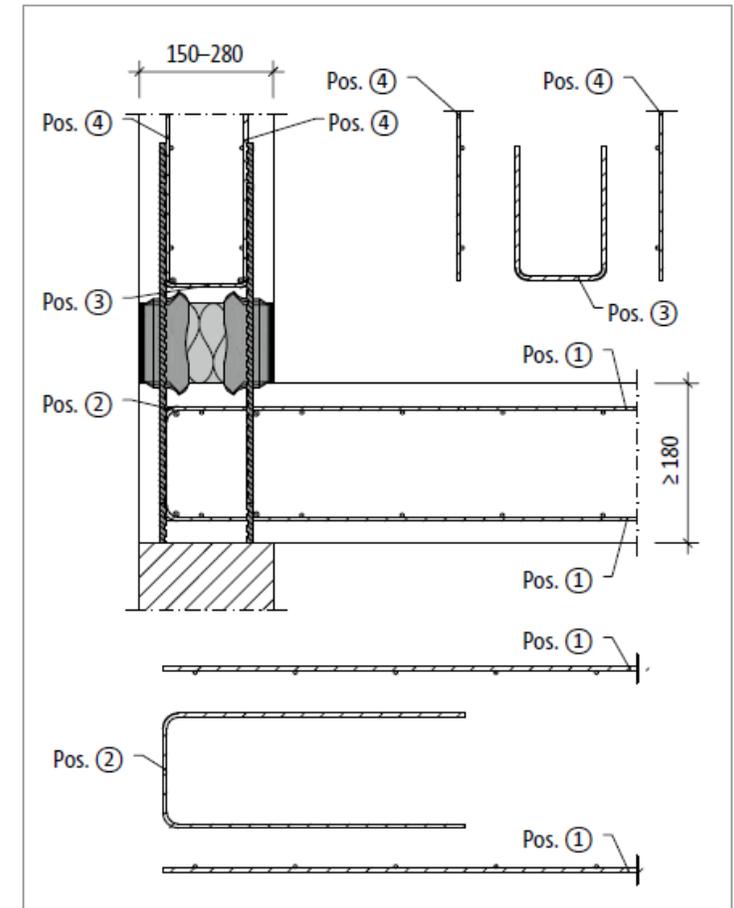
Schöck Isokorb® CXT Typ A: Bauseitige Bewehrung
